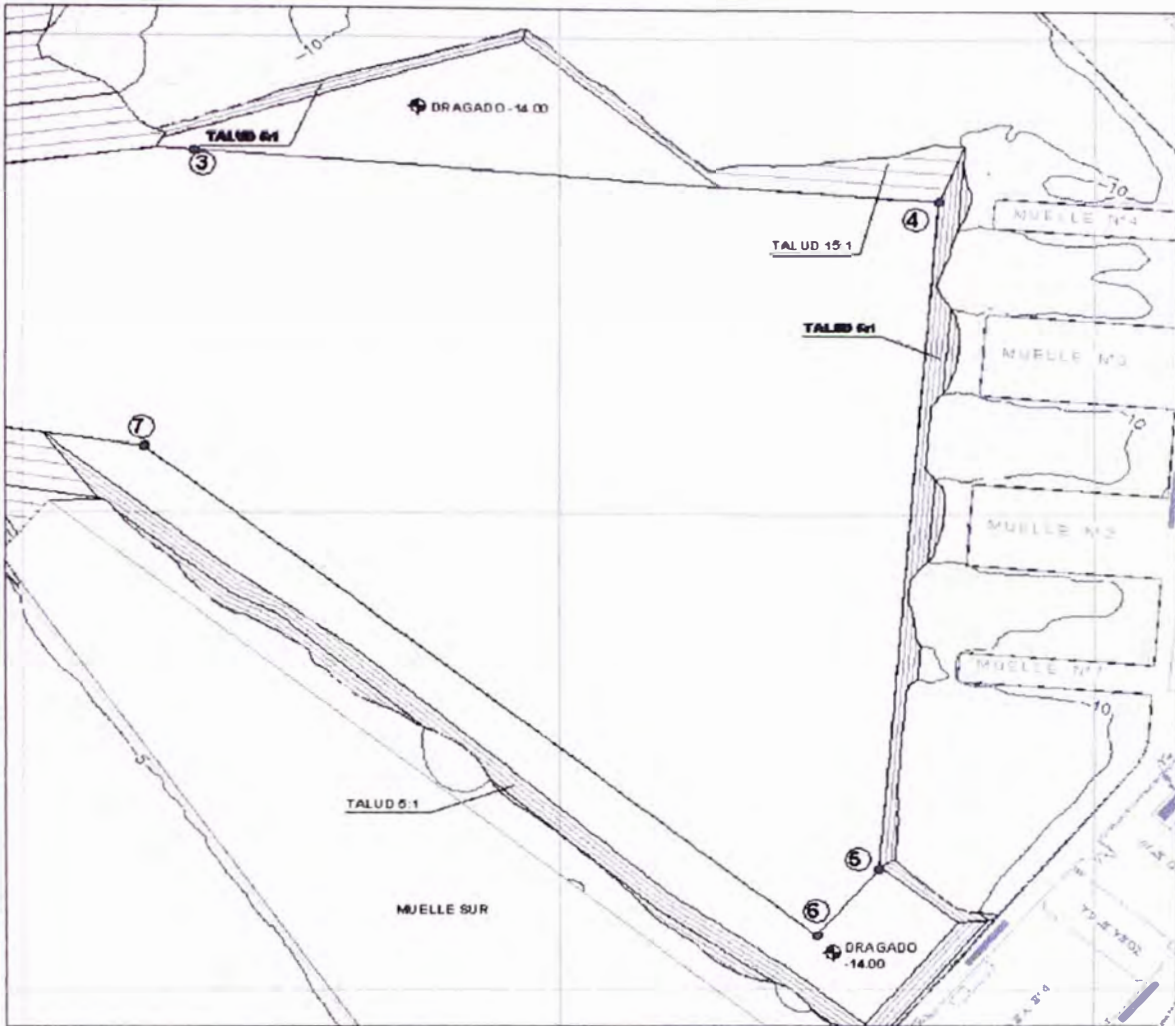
Planta de dragado Fase 1B – Rada interior
